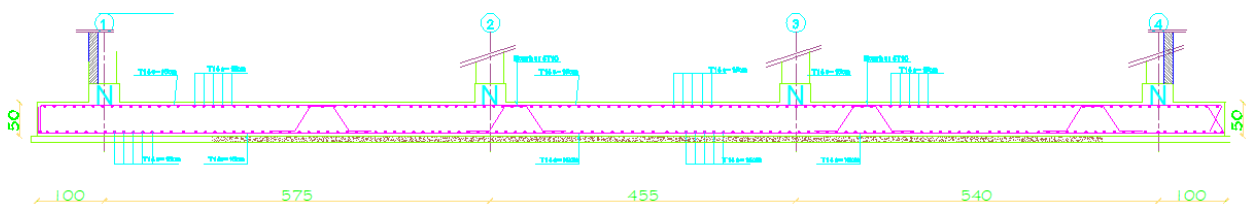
Ferrailage de la dalle du radier suivant les deux sens (x ; y)
